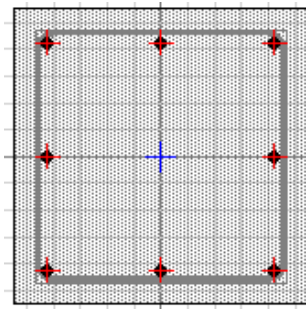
Sección de columna 55x55 con refuerzo longitudinal $8\phi 22$ mm.
